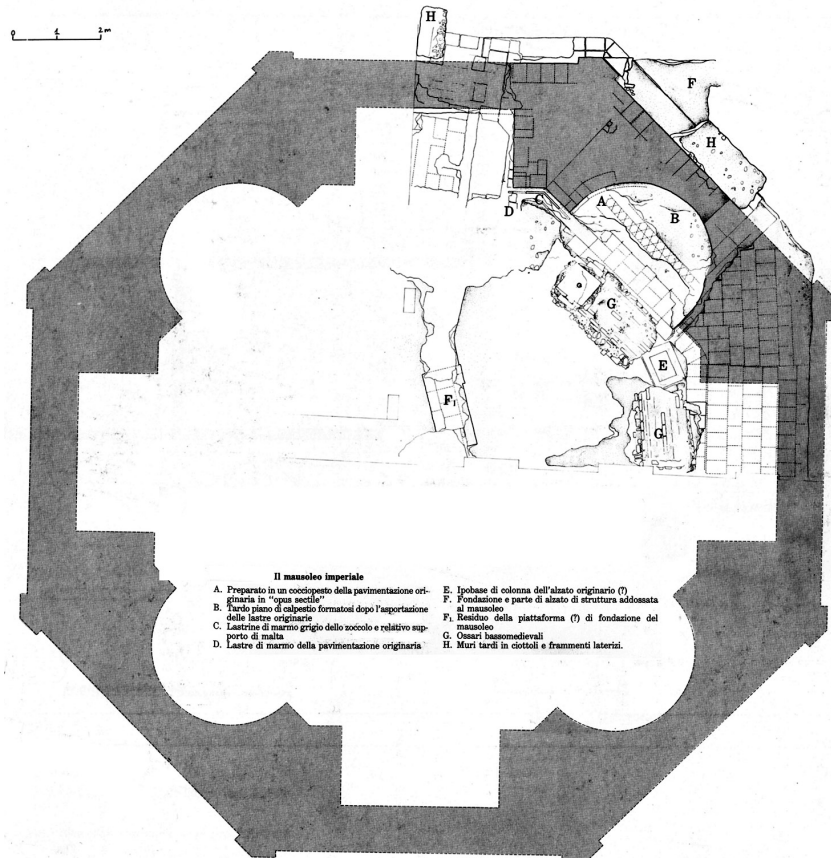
Milano, planimetria ricostruttiva del Mausoleo imperiale
